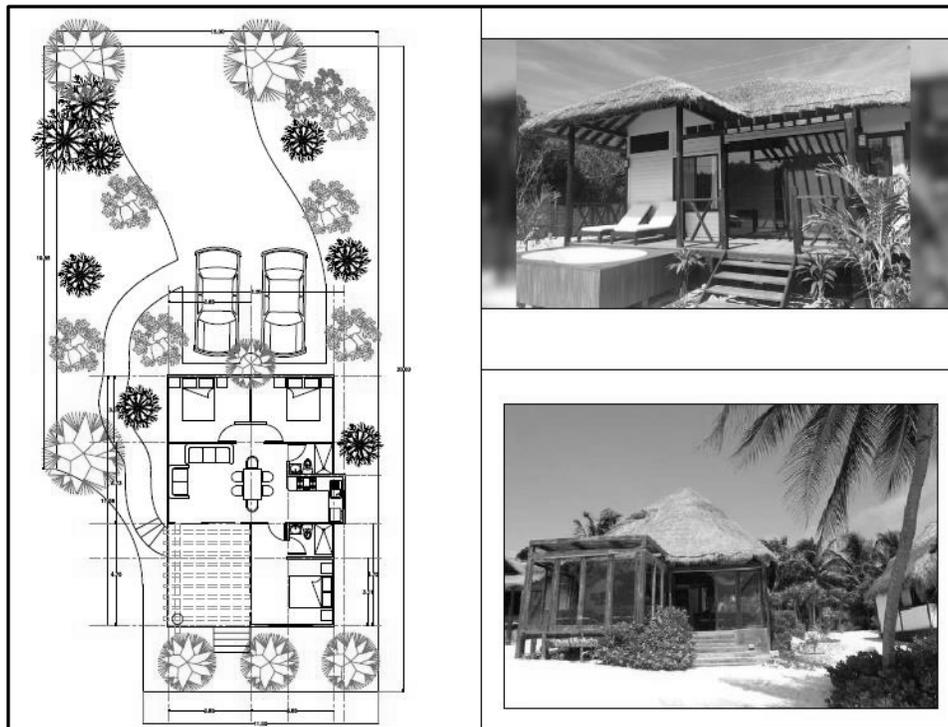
Planta y fachadas tipo, para los diseños arquitectónicos propuestos para el desarrollo.
